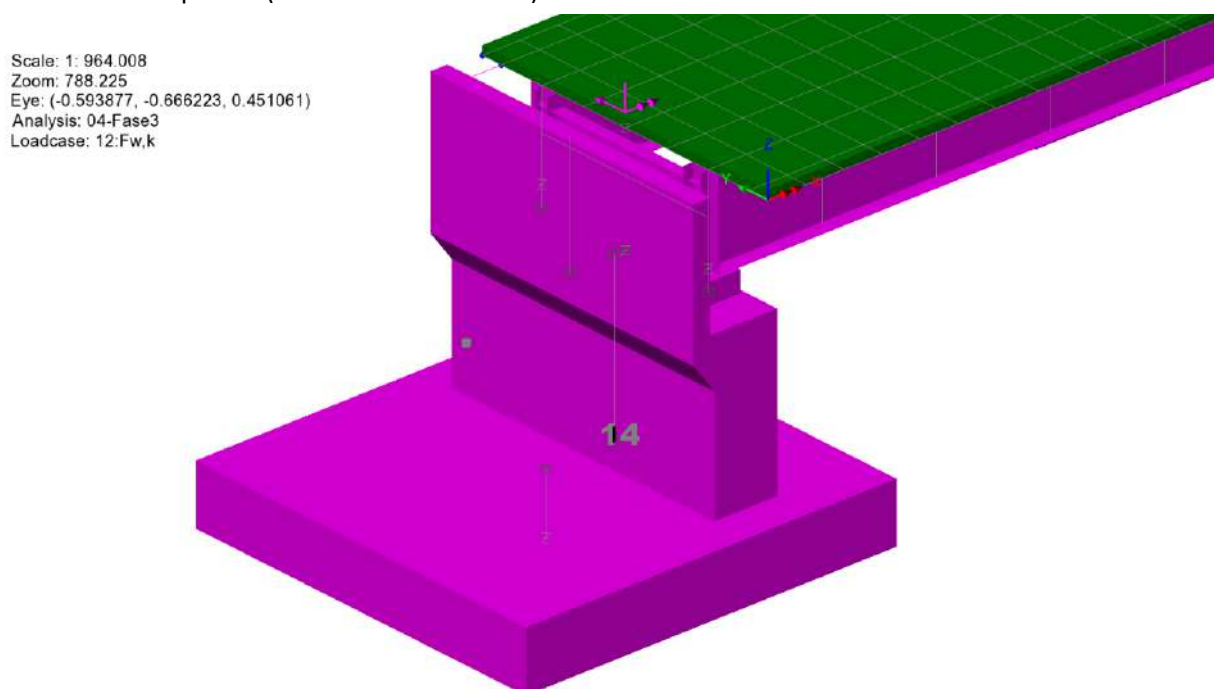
Elementi per la verifica del muro frontale della spalla e del paraghiaia
